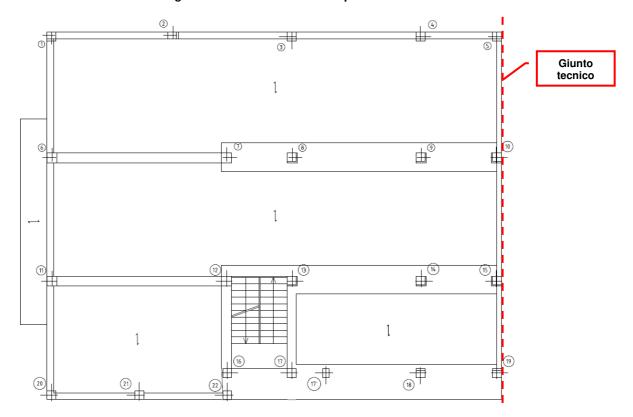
Pianta II impalcato Corpo A (pilastri piano rialzato).
